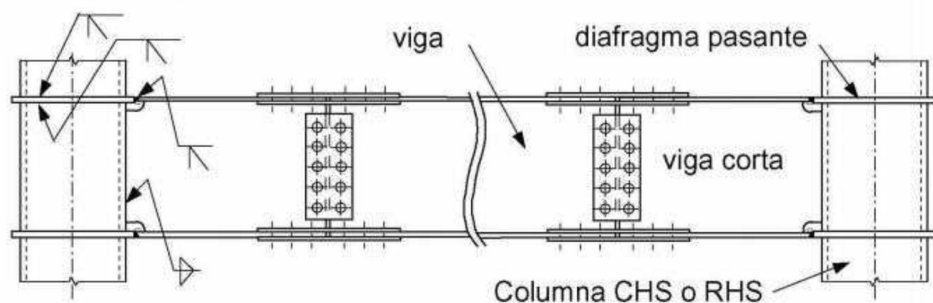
2- Conexión tipo diafragma pasante para aplicación de soldadura de taller [16]
